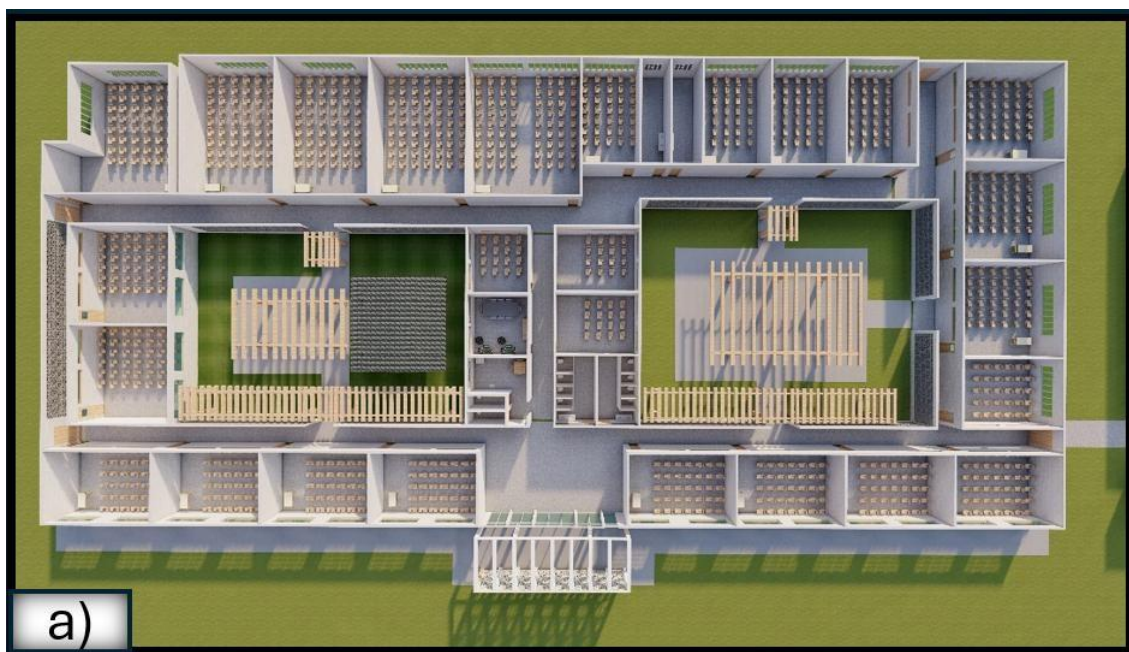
Proposta de atualização de projeto através da técnica de Retrofit. a) Pavilhão retrofitado.
